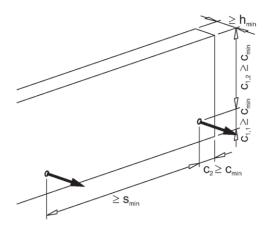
Einbausituation Wandfläche - Zugbeanspruchung, ohne Rückhängebewehrung
